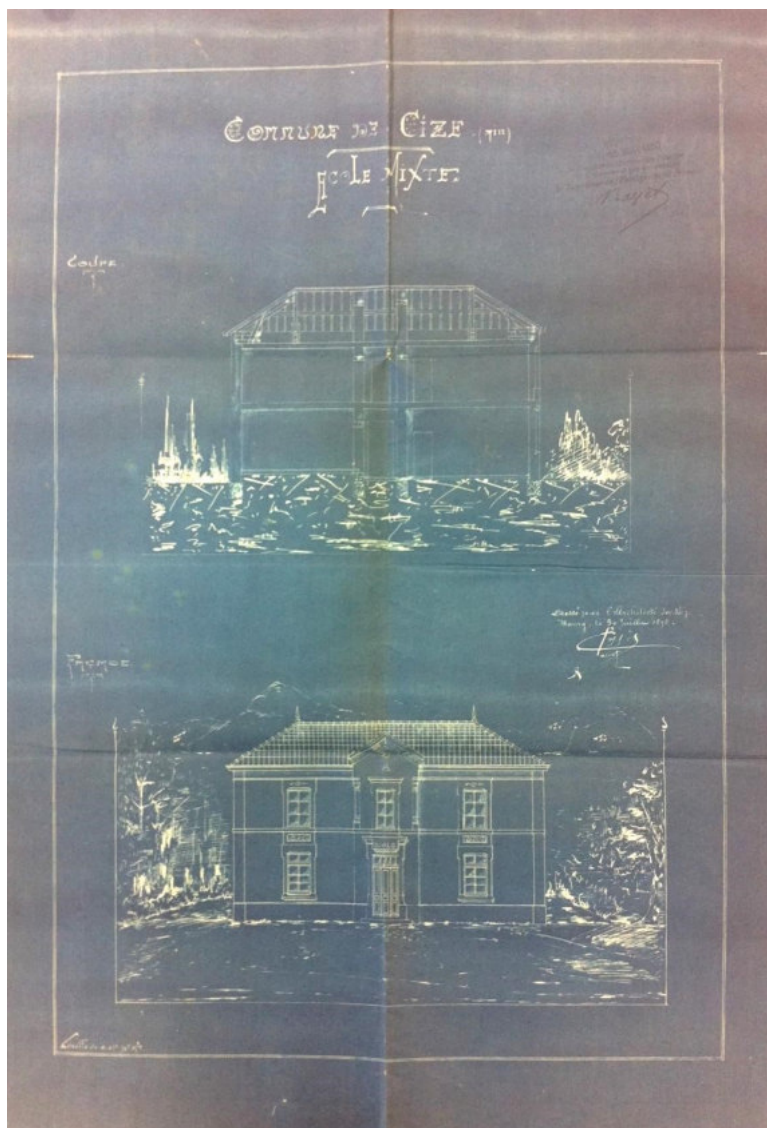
Plan de la façade de l'école mixte, 4M2 (1898).
